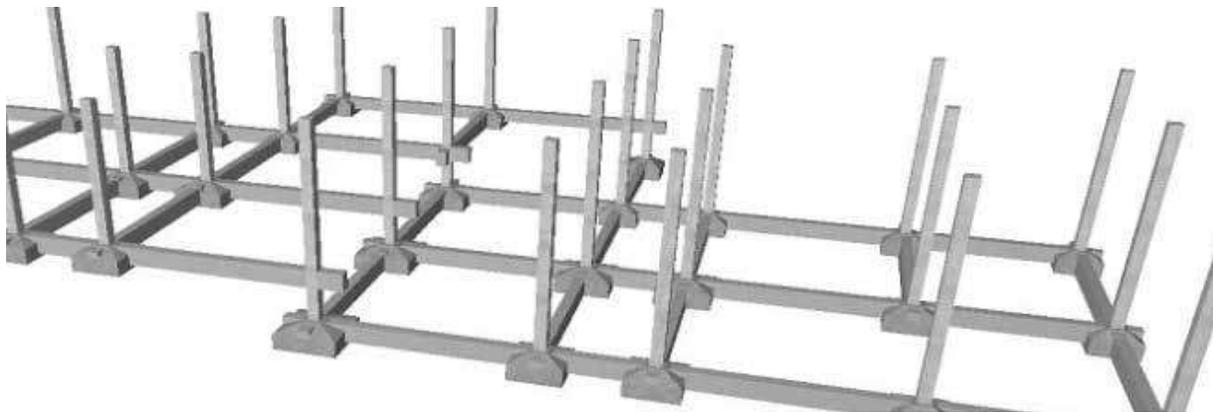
Cimentación a base de zapatas aisladas/ Elaborado por LAS
